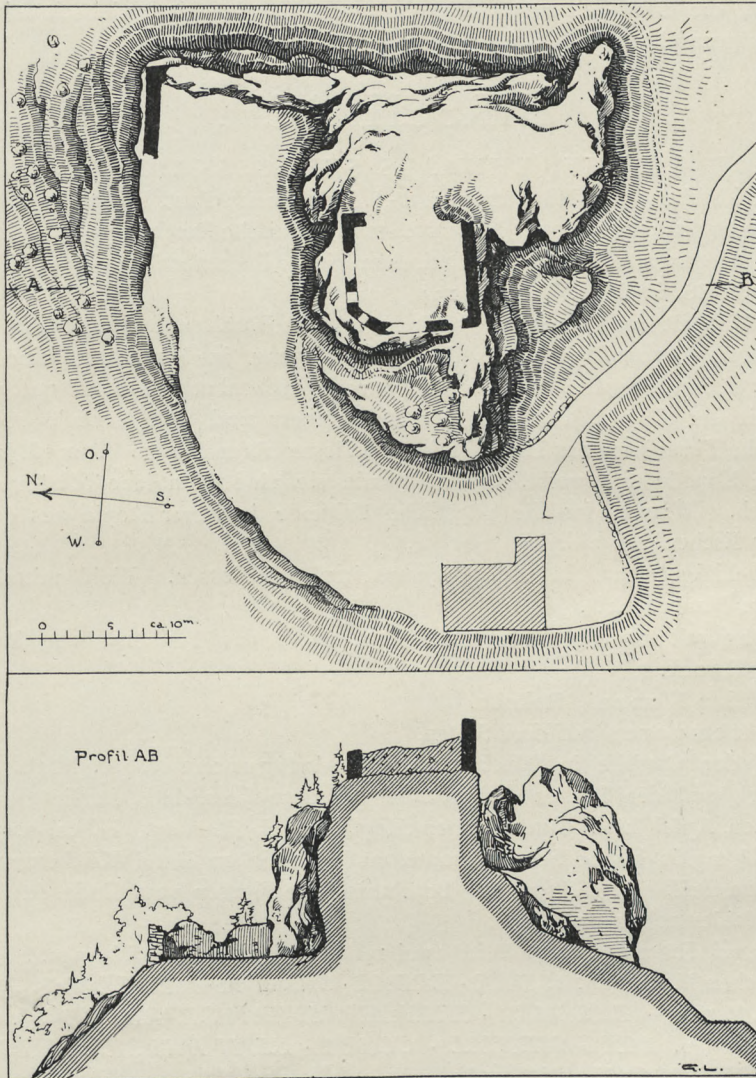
Hauseck. Grundrißskizze und Profil der Schloßruine.
